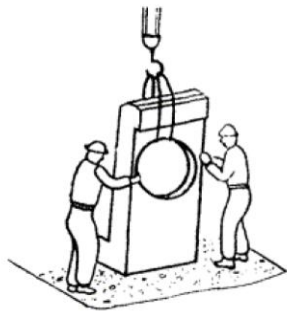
Монтаж порталной стенки    Рисунок 3.5 – Монтаж откосной стенки
